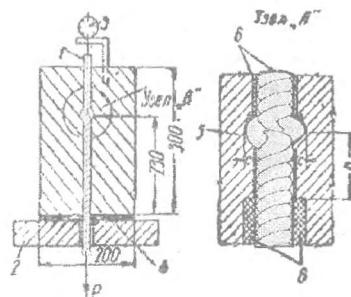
Установка для испытаний бетона на смятие утолщением СПА:
